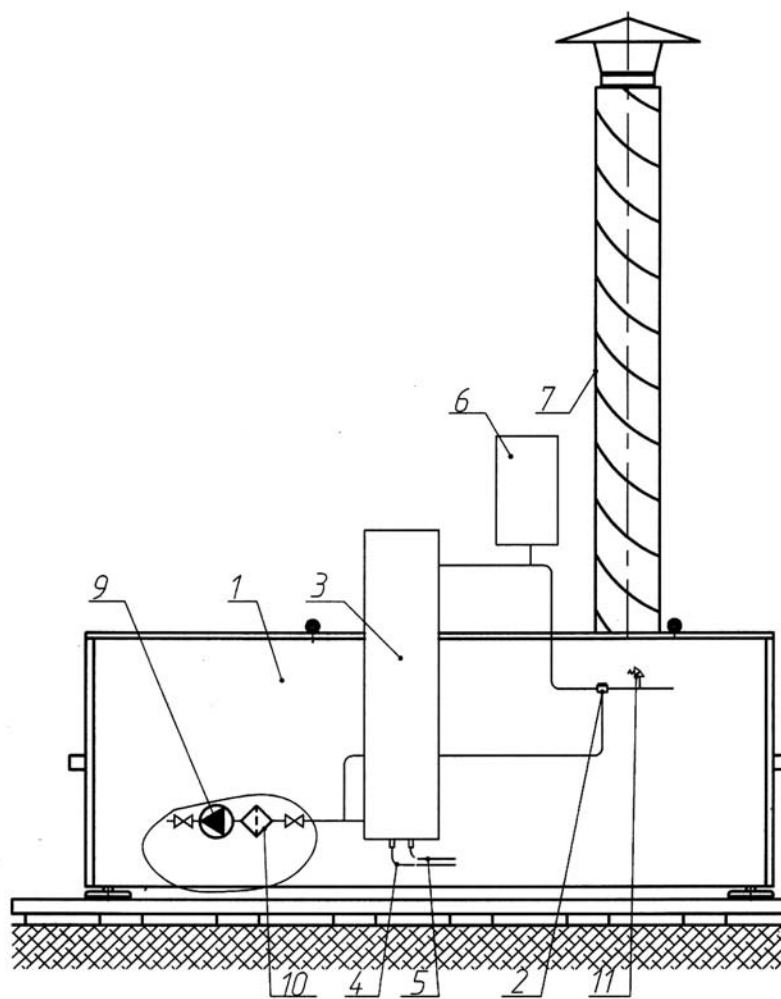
Схема установки котла КСВ для автономной системы горячего водоснабжения: 1 – котел КСВ; 2 – автоматический трехходовой кран; 3 – подогреватель ПВ; 4 – подвод холодной воды; 5 – вывод горячей воды; 6 – расширительный бак; 7 – дымовая труба; 8 – кронштейн; 9 – насос; 10 – фильтр; 11 – предохранительный клапан
